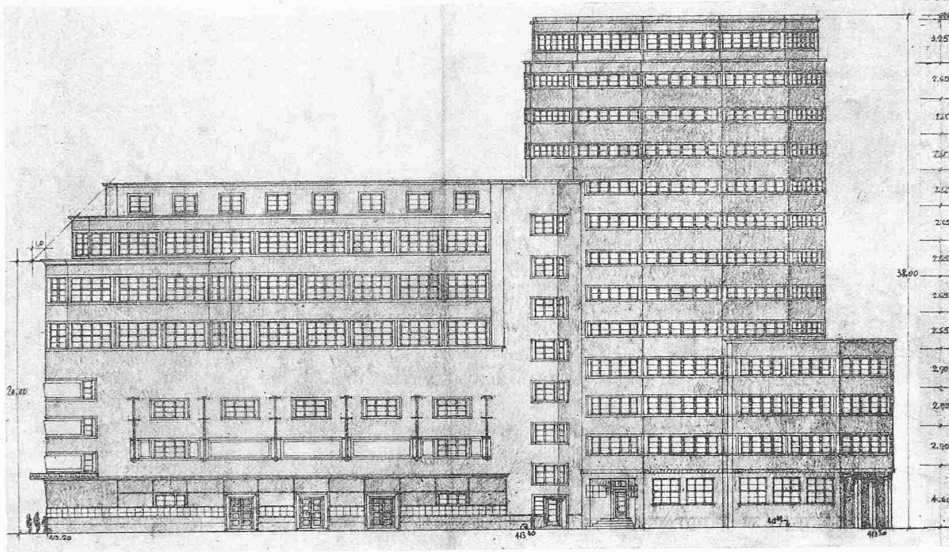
Der anfänglich geplant gewesene Baublock mit Kino- und Geschäftshaus (links) und Grossgarage für 165 Autos (Grundriss S. 124, unten rechts). Fassade an der St. Annagasse, Masstab 1 : 500.
